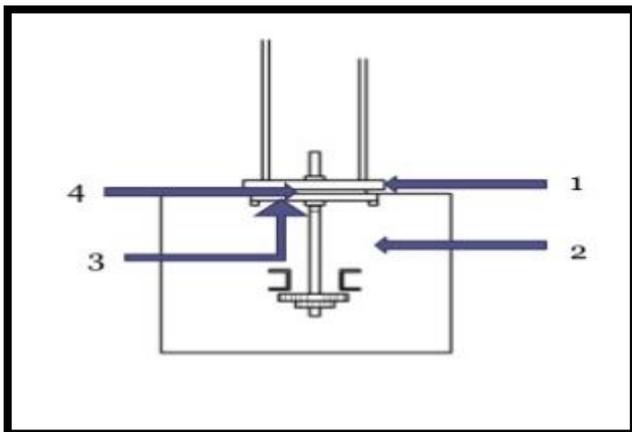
Pied de poteaux articulé au moyen d'une cornière et plaque d'appui
